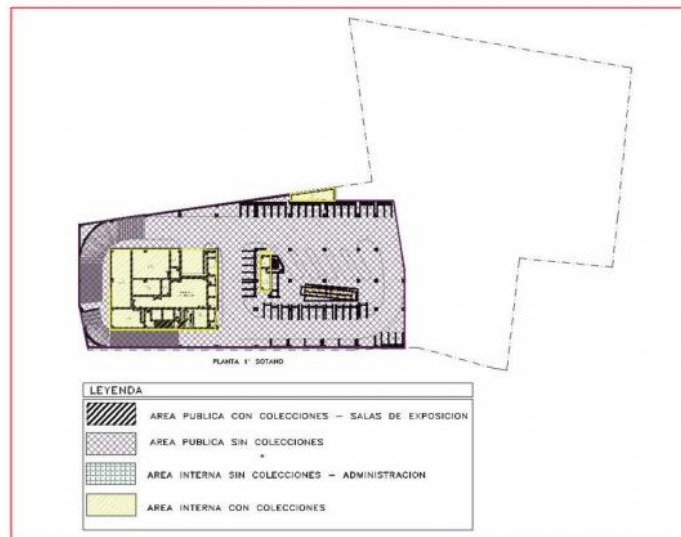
Planta 1. Sótano. Fuente: Equipo consultor.
